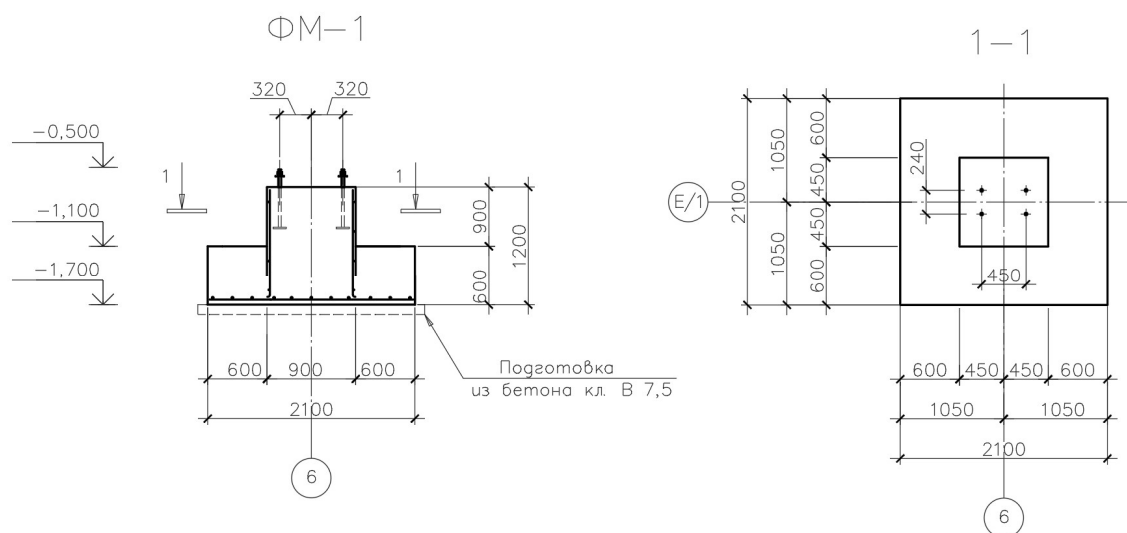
Конструирование столбчатого фундамента ФМ-1 под колонну К9
